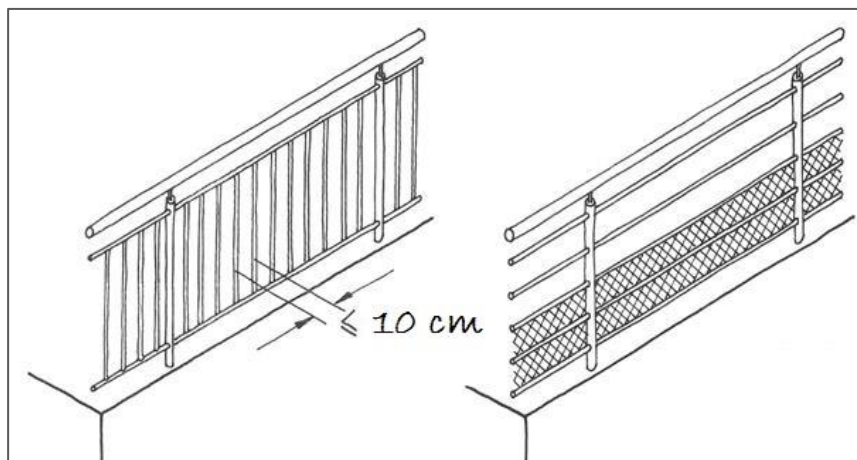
géométrie des garde-corps (entraxe entre barreaux verticaux et dispositif empêchant d'y grimper)
